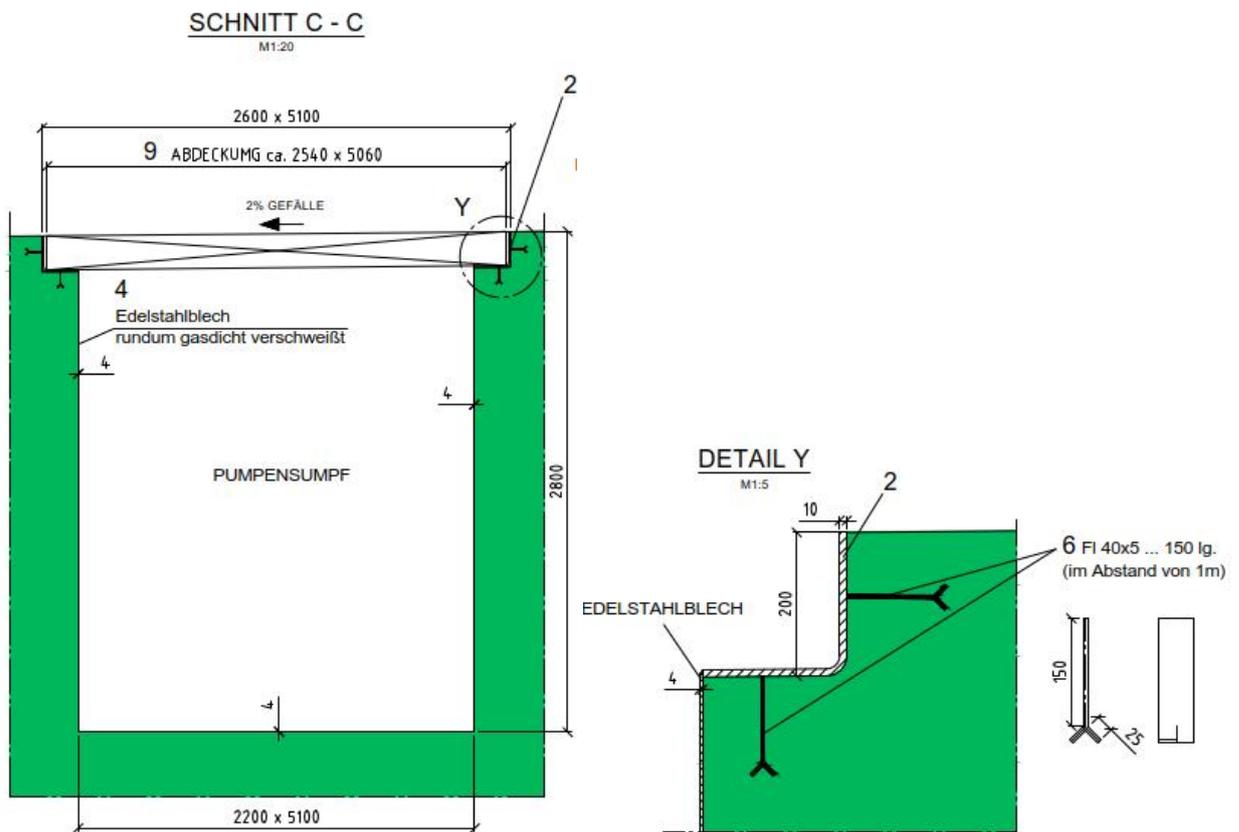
Detail zum Auffangschacht mit Edelstahlauskleidung; Blechdicke 4 mm
